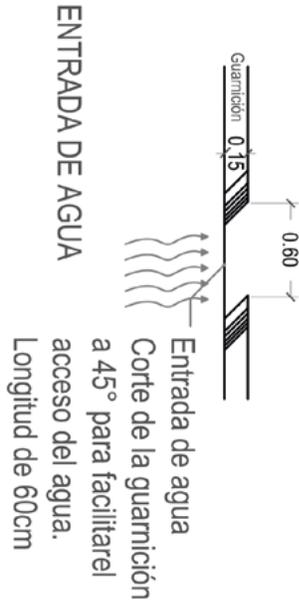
Detalle Constructivo del Jardín de Lluvia
